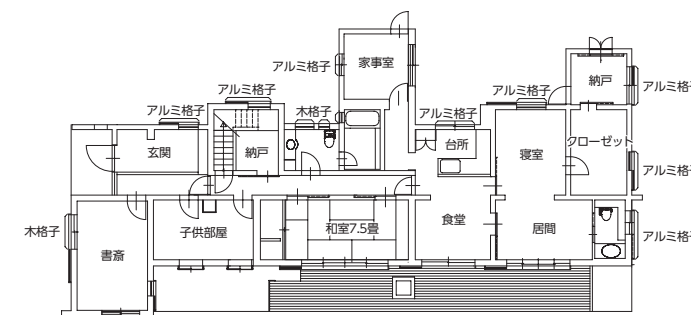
伊藤家住宅現状調査 1階平面図 縮尺1/300
